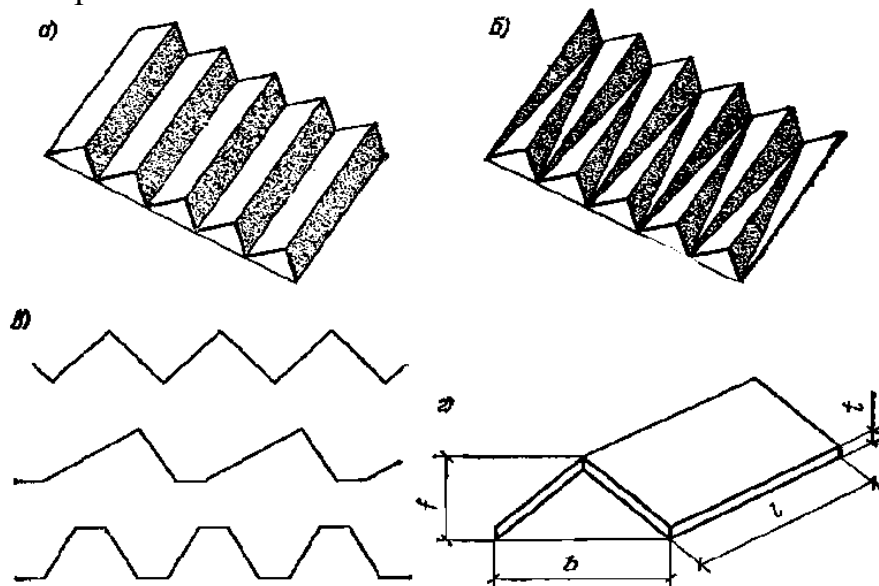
Схемы складчатых покрытий. а) складки с прямоугольными гранями б) складки с треугольными гранями в) форма профиля многоволновой складки г) параметры складки
